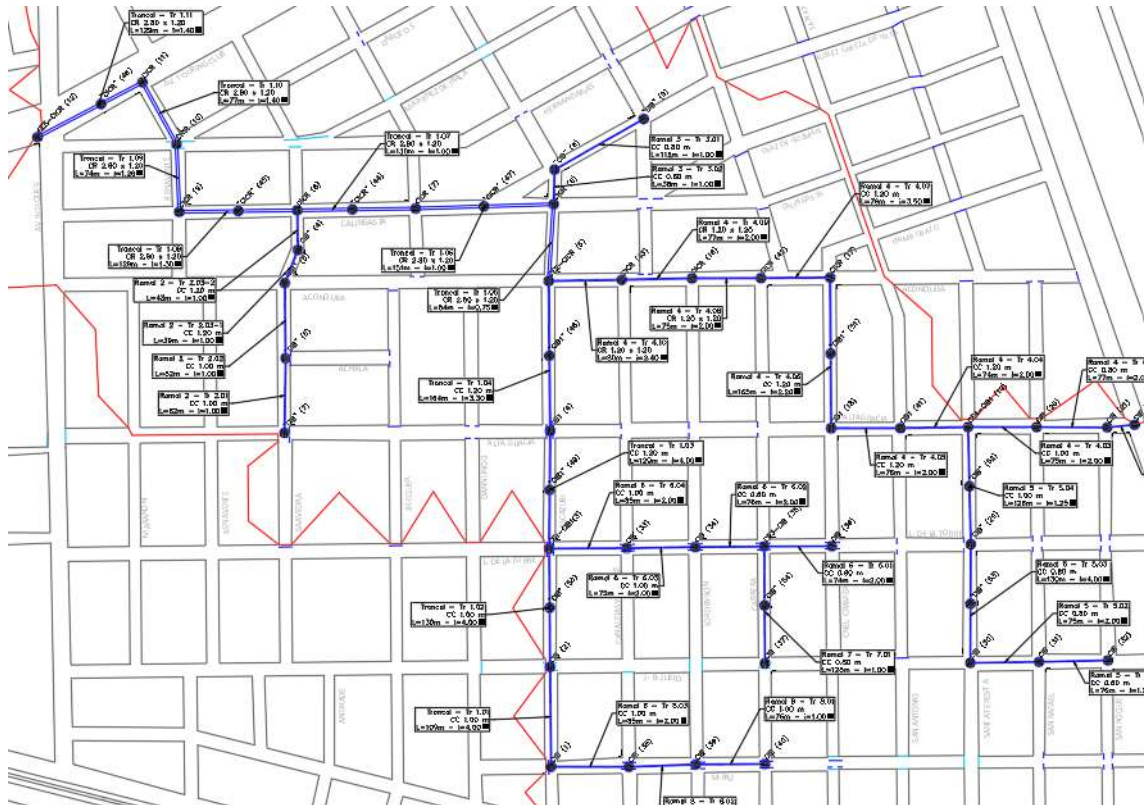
Planimetría de Conductos, cuenca Bosques Norte. Fuente: Departamento de proyectos – DPH.
